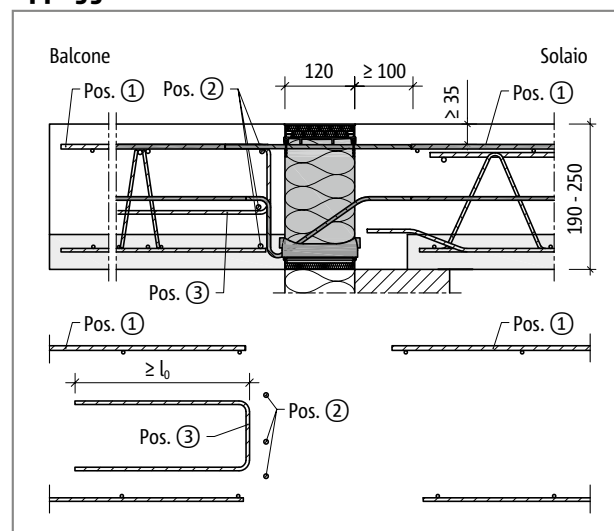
Schöck Isokorb® XT tipo KL-F: armatura in opera con spessore del balcone $h = 190 - 250$ mm
